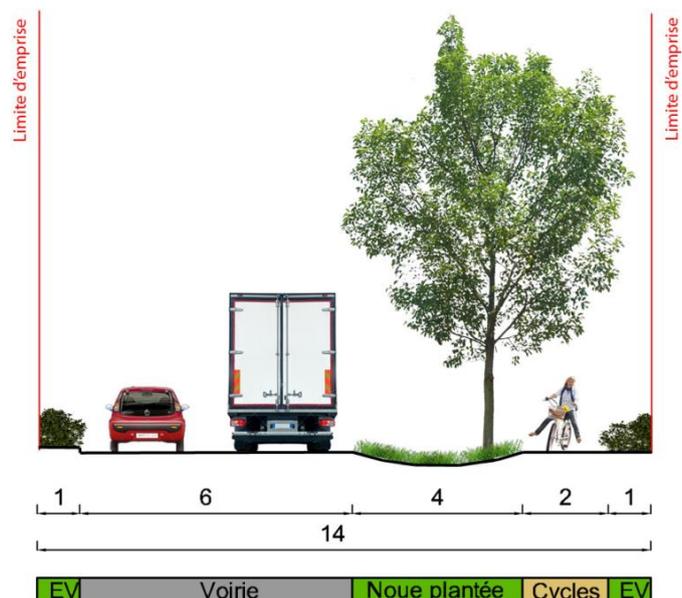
Profil type des voies tertiaires : profil 2 : avec voie verte
